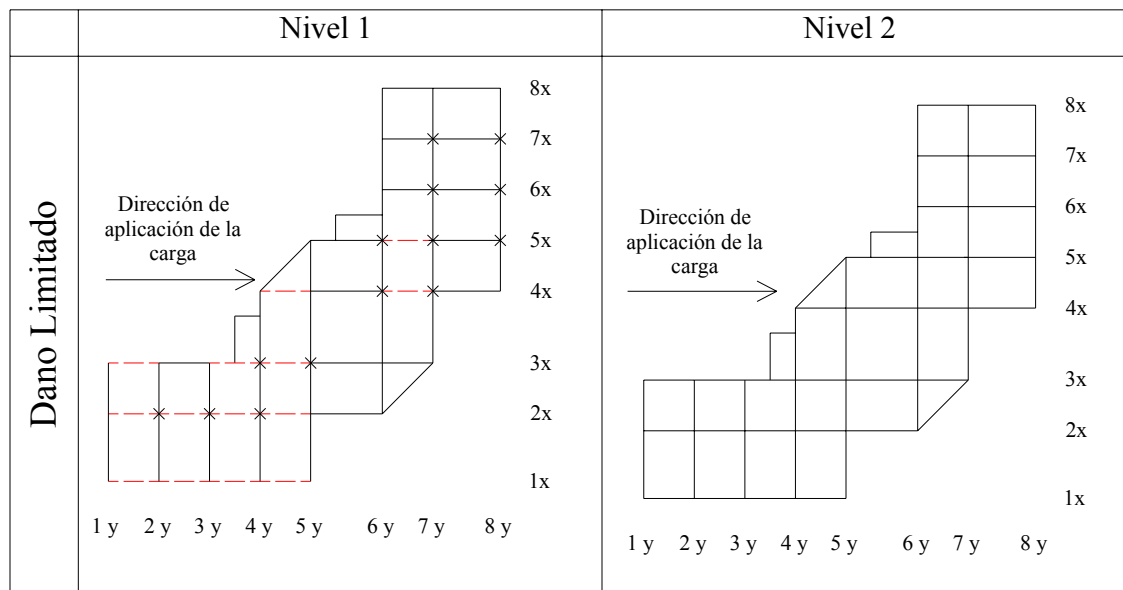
19 Vista en planta Niveles 1 y 2, para E.L. de D.L.
